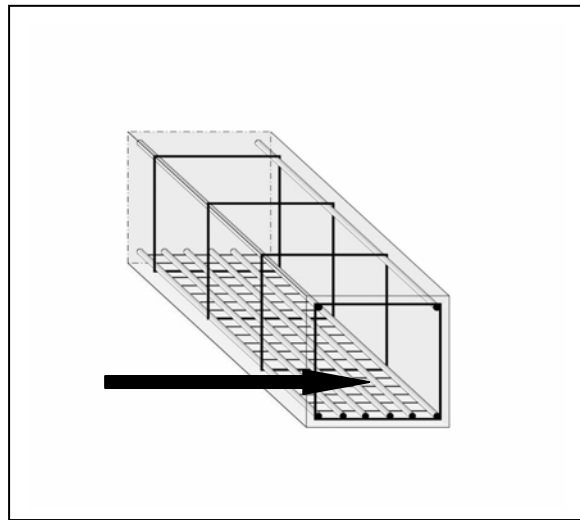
Lage der Bewehrung vor dem Betonierprozess
